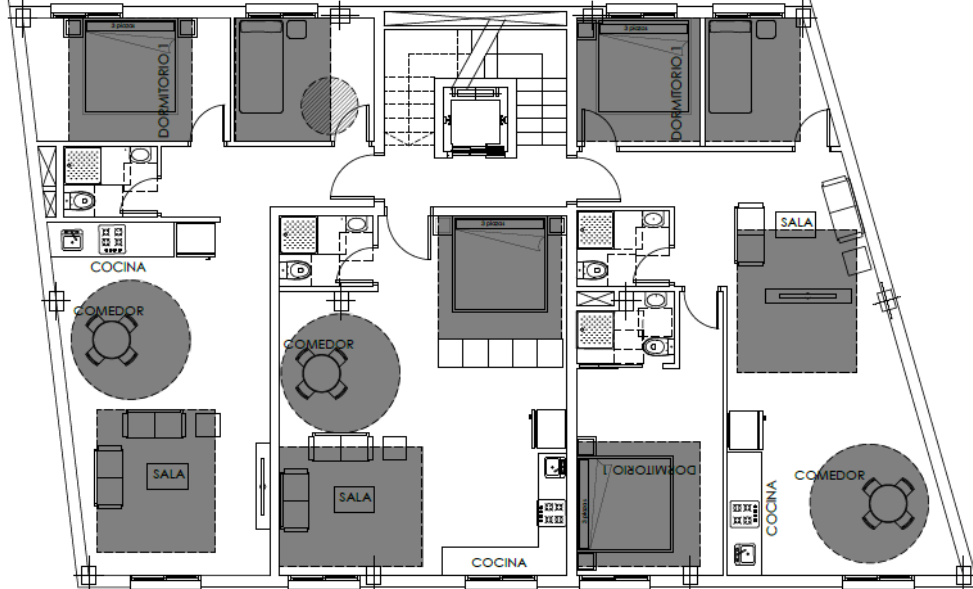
Distribución Planta 1 y 2. Fuente: Propia (2019)
